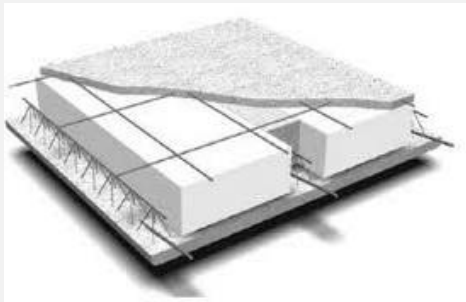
Tipuri de planșee din b.a. (Predală) și planșee mixte oțel-beton.
